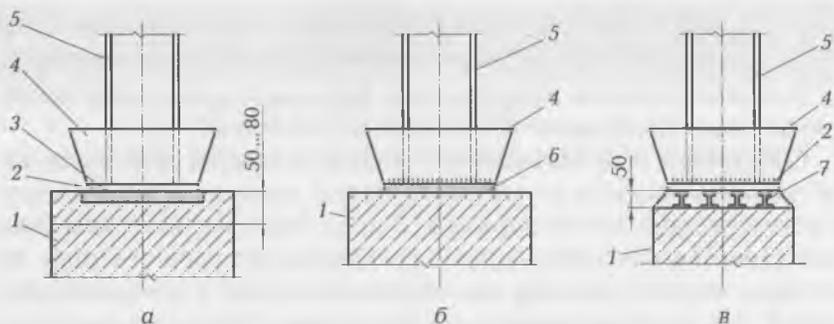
Схемы опирания металлических колонн на фундаментах:
